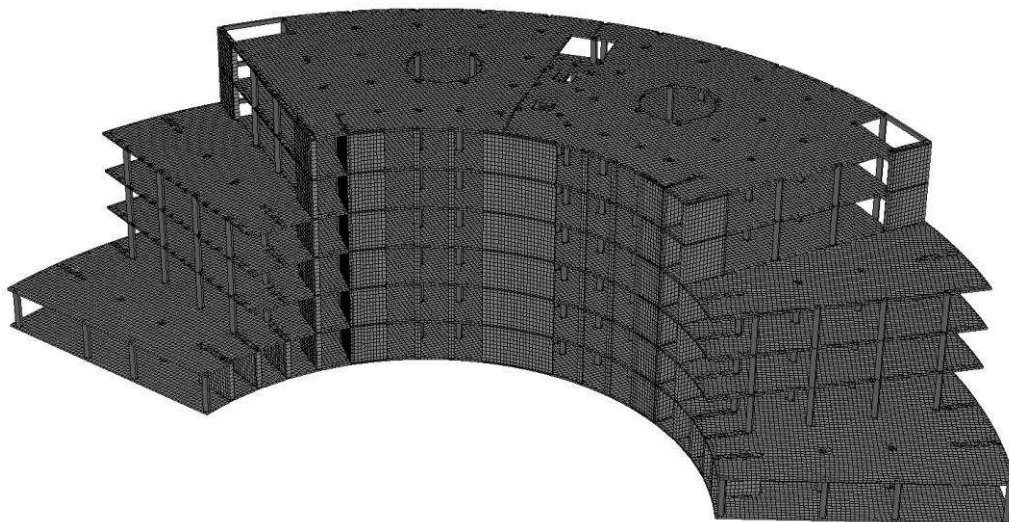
Расчетная схема железобетонного каркаса здания.
